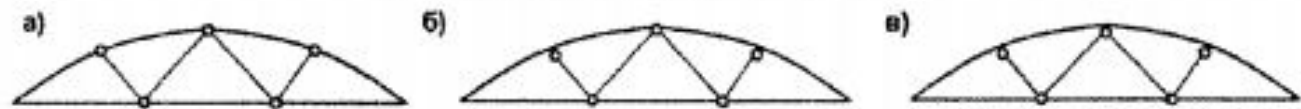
Схеми верхнього поясу сегментних ферм
